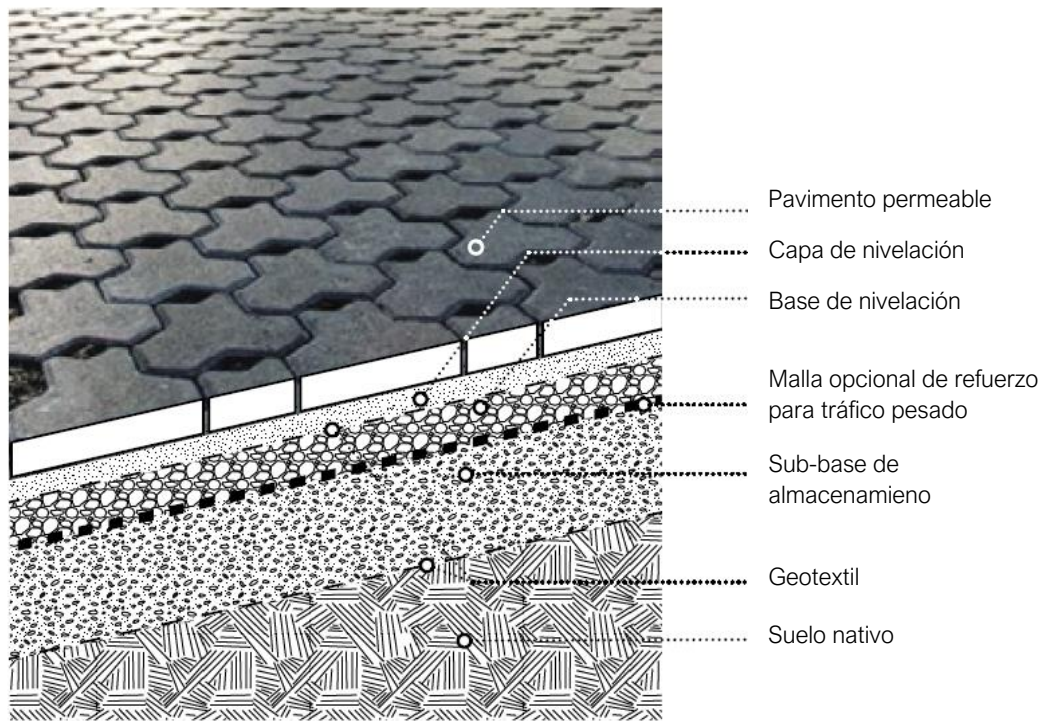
Pavimentos Permeables - Especificaciones Técnicas
